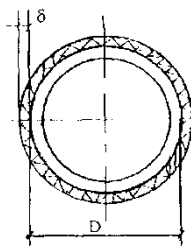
Расчетная схема определения фильтрационных сопротивлений для труб керамических со сплошной оберткой стеклохолстом
